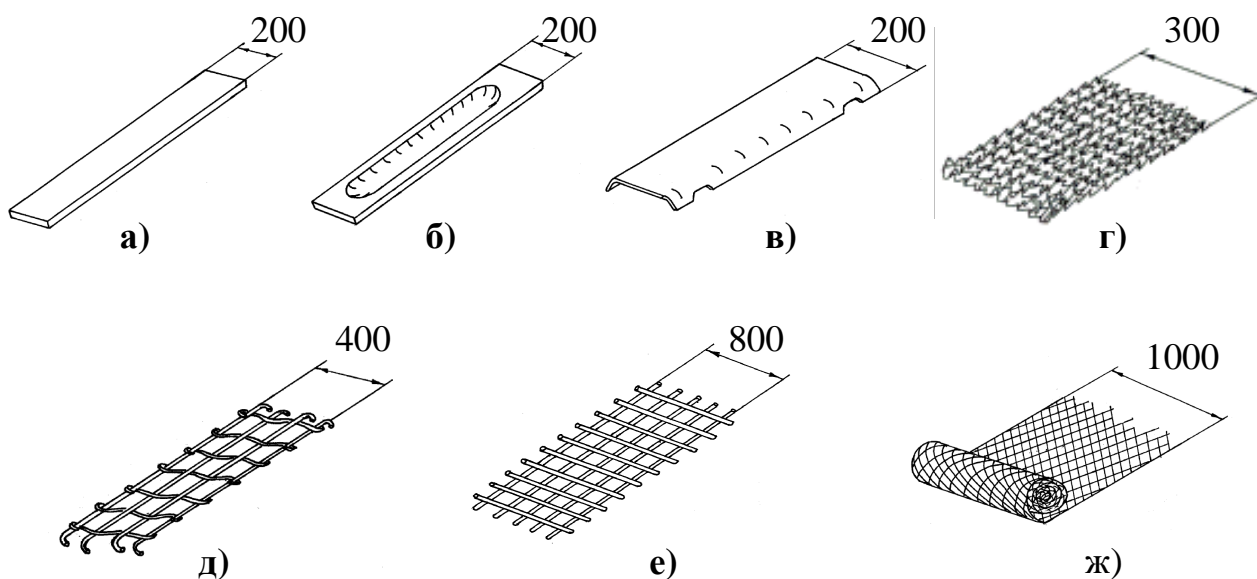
Разновидности межрамных перекрытий: а и б – железобетонные соответственно плоская и со сводчатой полостью; в – металлическая коробообразная; г – перфорированная из листовой стали; д и е – сварные решетчатые соответственно из металлических прутьев и ленты; ж – рулонная из стеклопластика
